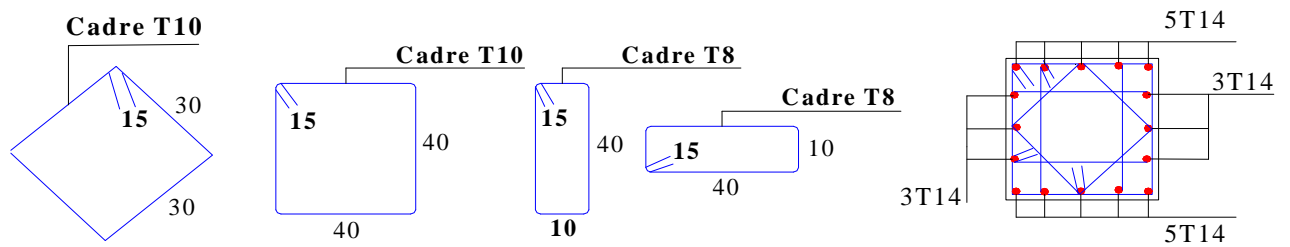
Schéma de ferrailage des poteaux étage 05 et 06
